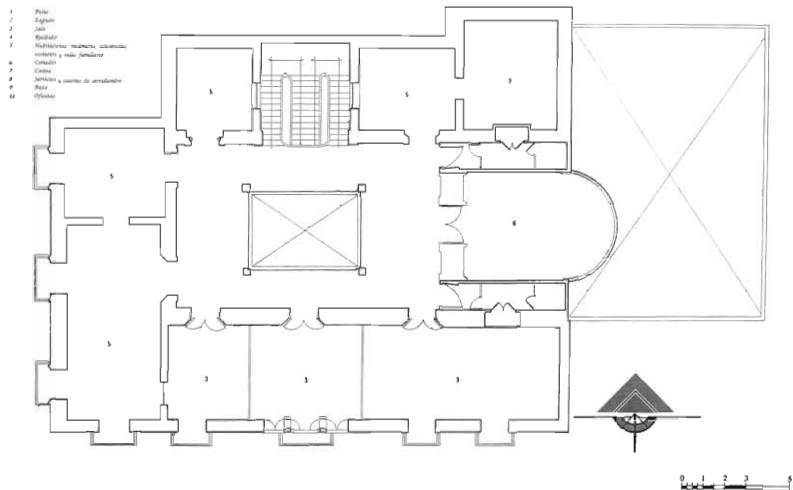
GUERRERO ESQ. ARMENTA Y LÓPEZ. PLANTA ALTA.
